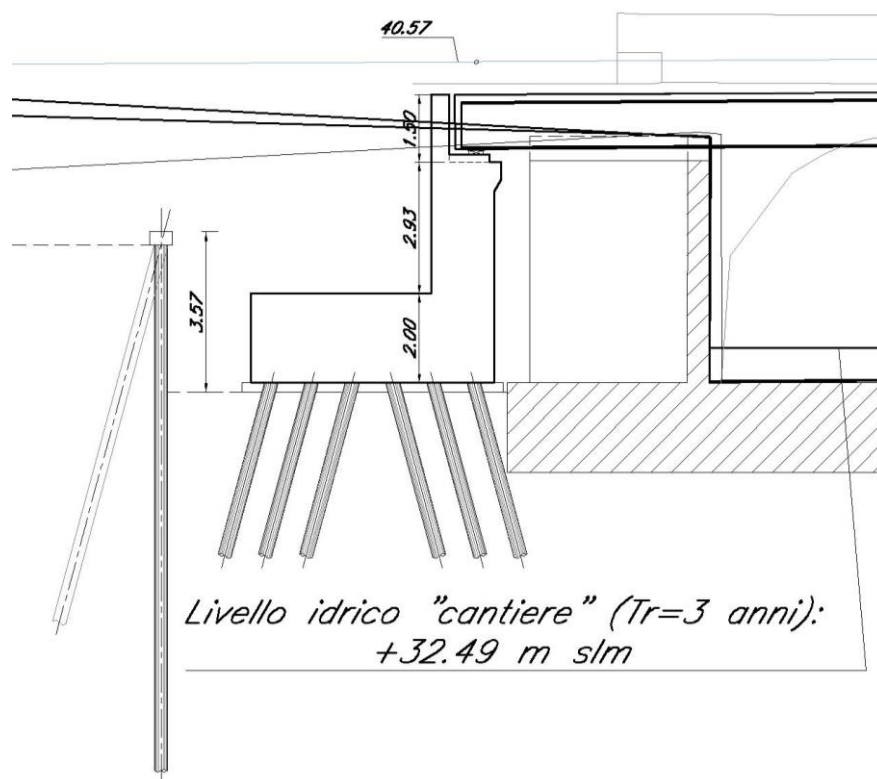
Spalla A – paratia di micropali a cavalletto per realizzazione spalla – sezione longitudinale A
